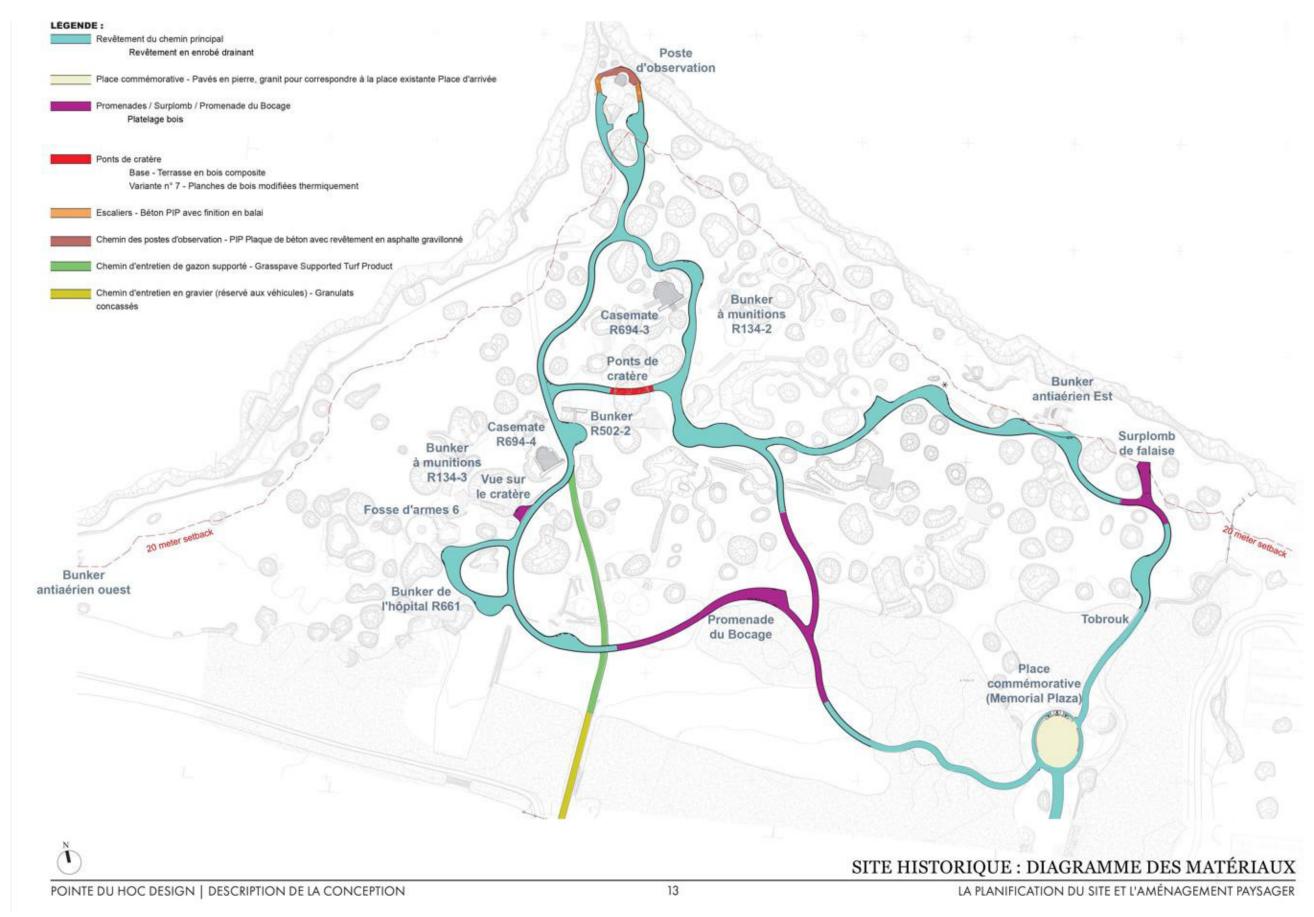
Plan d'implantation des cheminements liés aux bunkers
